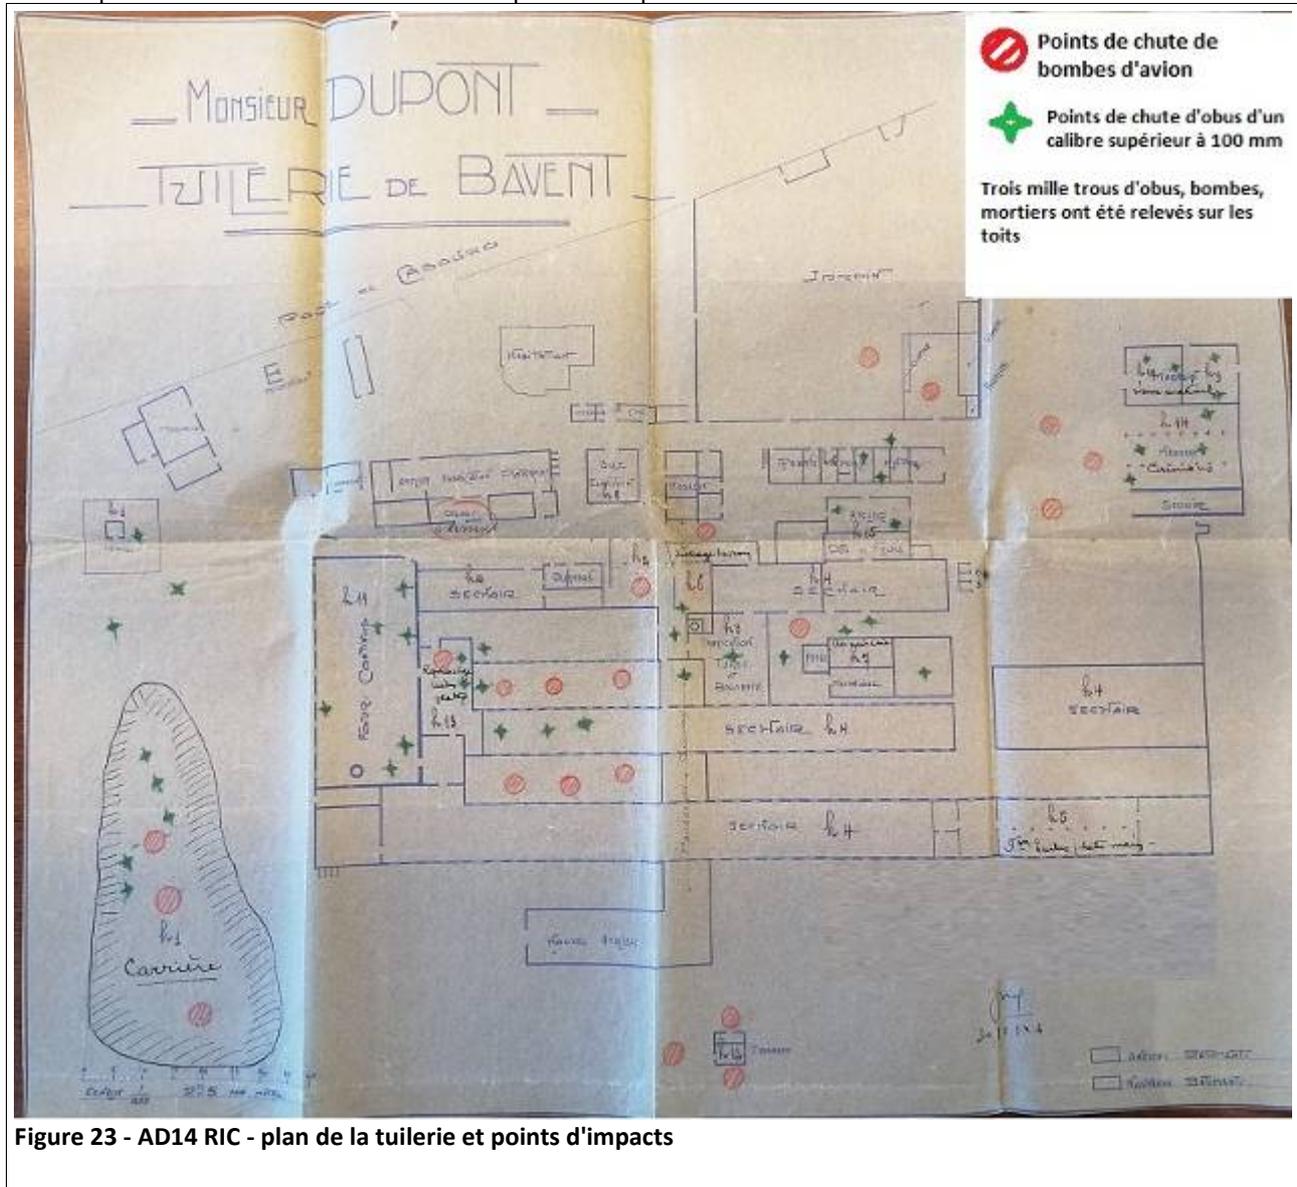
AD14 RIC - plan de la tuilerie et points d'impacts
